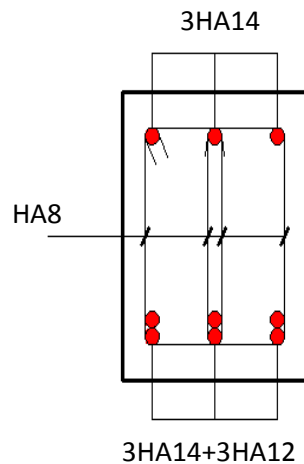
Coupes verticales des poutres secondaires adhérees aux voiles au niveaues travées
